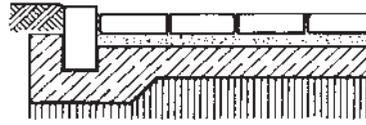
Borde elevado. Unos 2 cm aprox. sobre la superficie del pavimento.
